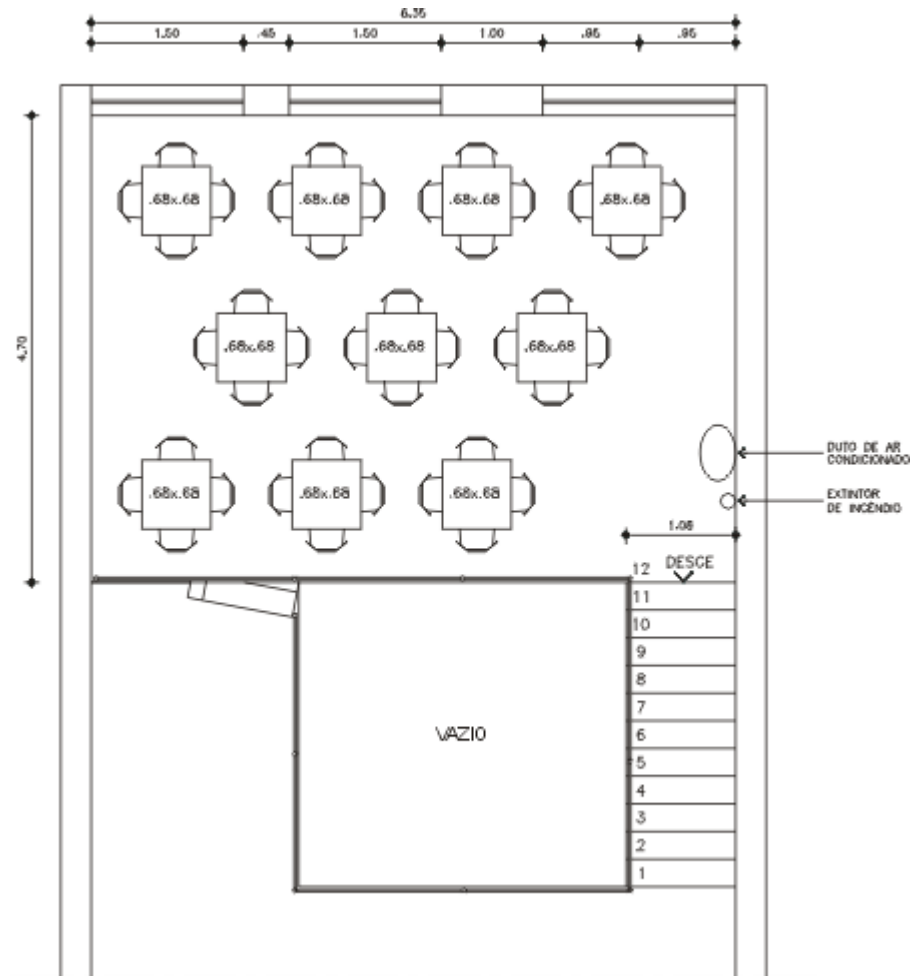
B – Planta baixa (lay-out) do segundo mezanino.
